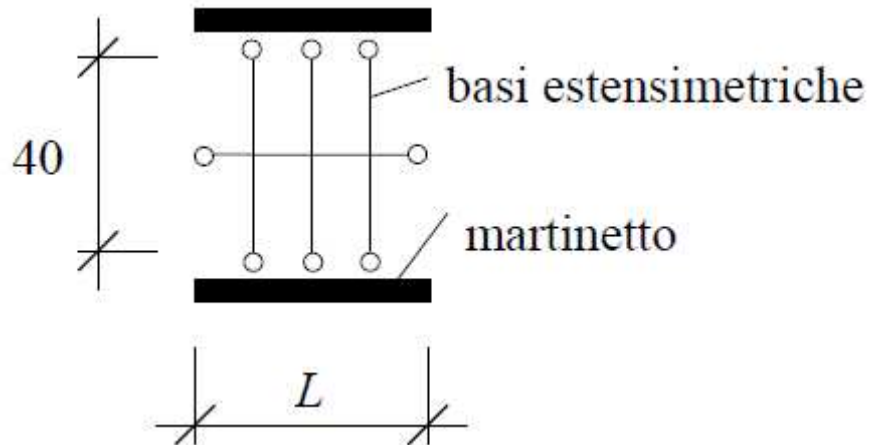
Disposizione del martinetto piatto e delle basi estensimetriche di misura
